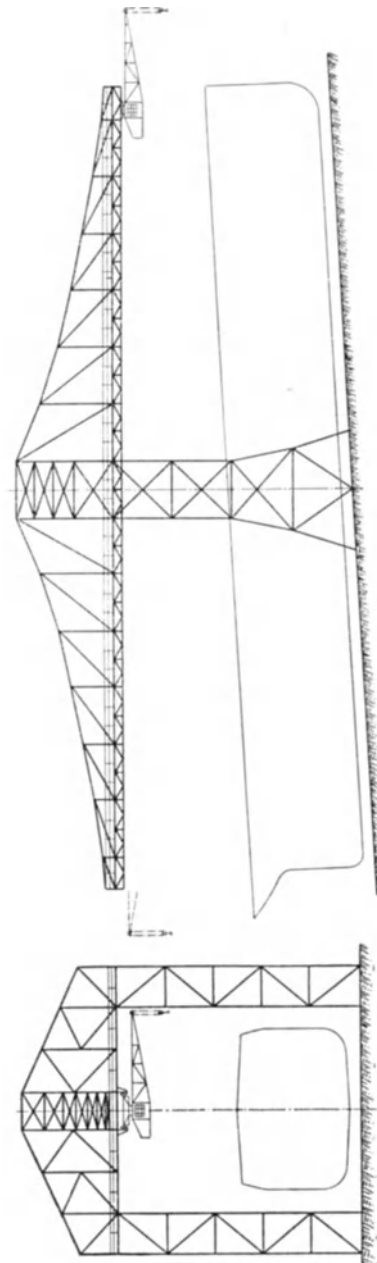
Krananlage mit feststehendem Ausleger-Stützbock für kleinere Hellinge.
